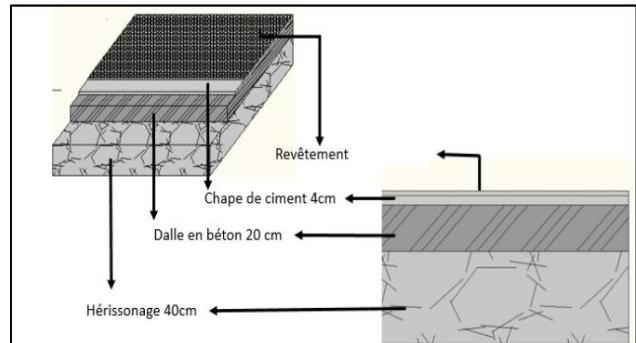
Détail schématique des matériaux composant le plancher bas (L.M. Miquel, repris par l'auteur, 2025).
